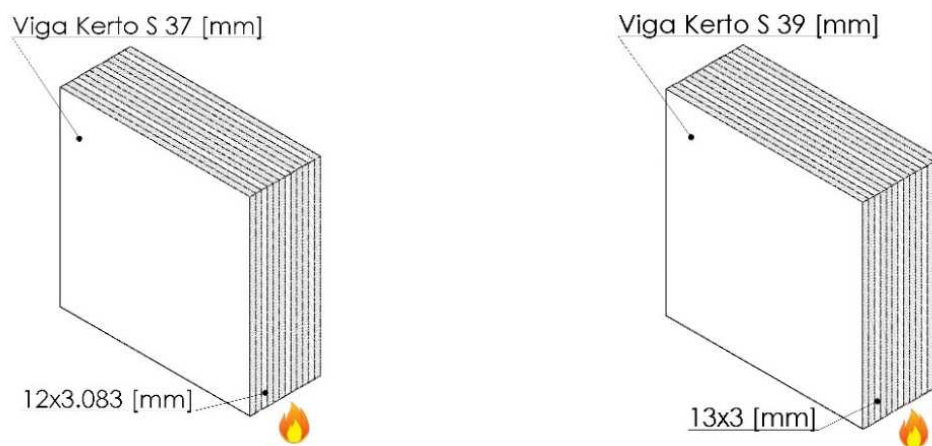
Pormenor construtivo, vigas Kerto S de 37 e 39 [mm].
